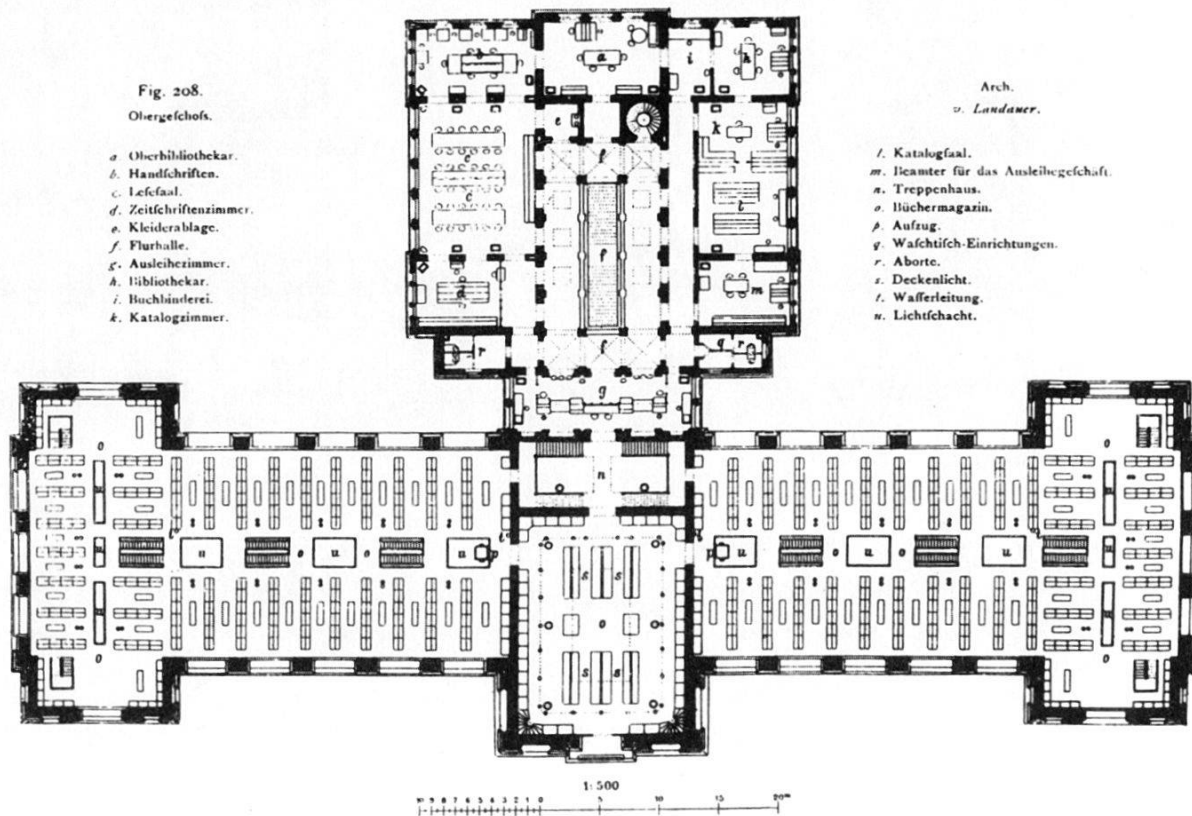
Landesbibliothek Stuttgart 1885, Grundriss 1. Stock.
